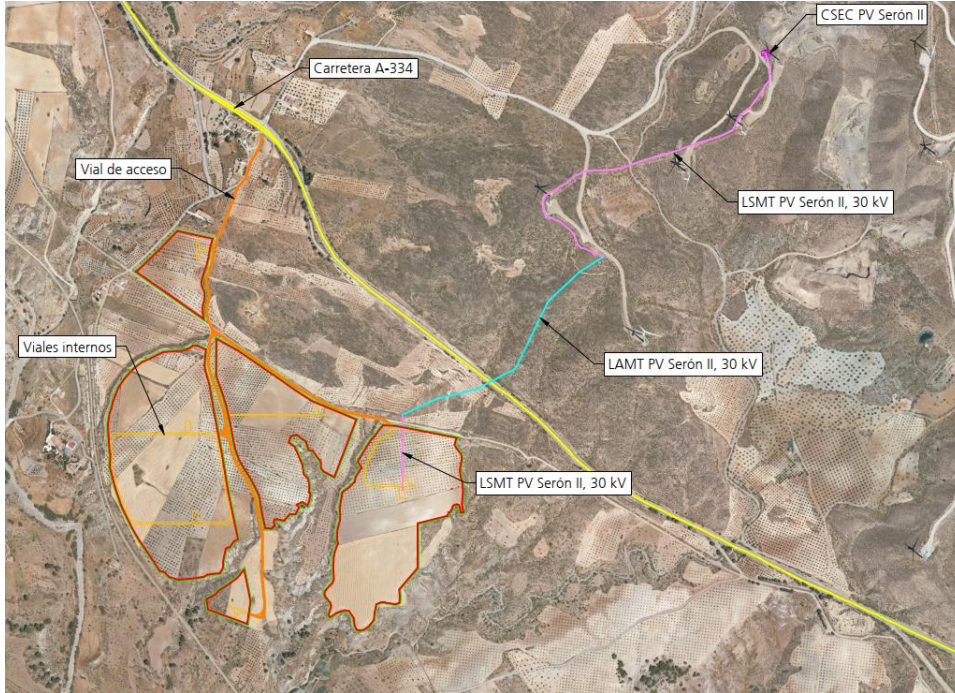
Detalle de acceso y caminos internos de la planta fotovoltaica.
